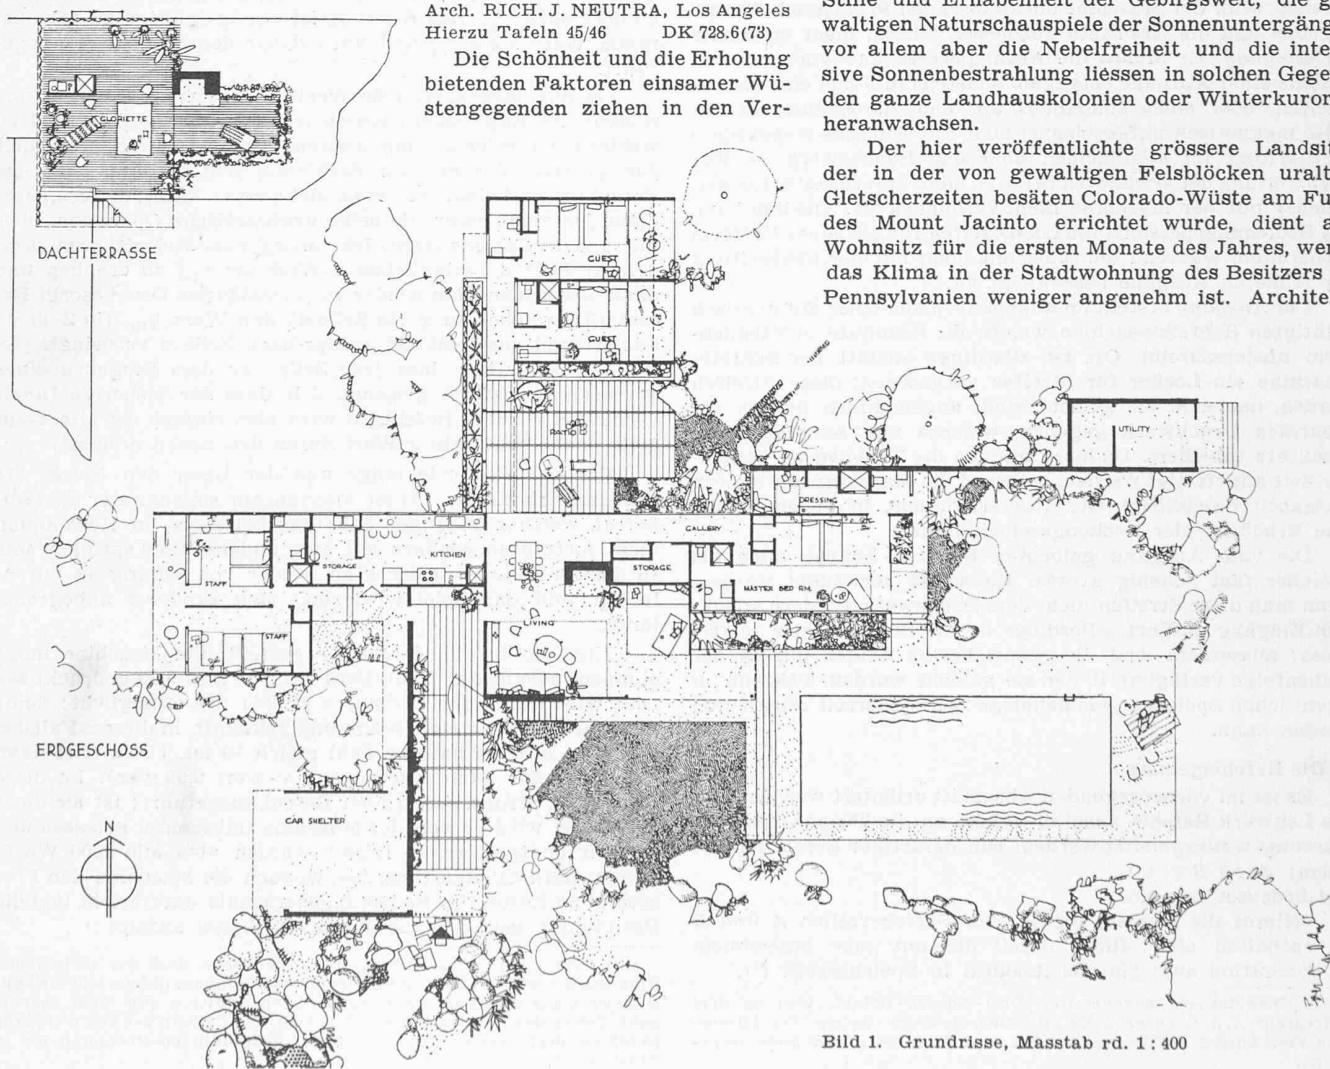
Grundrisse, Masstab rd. 1:400
